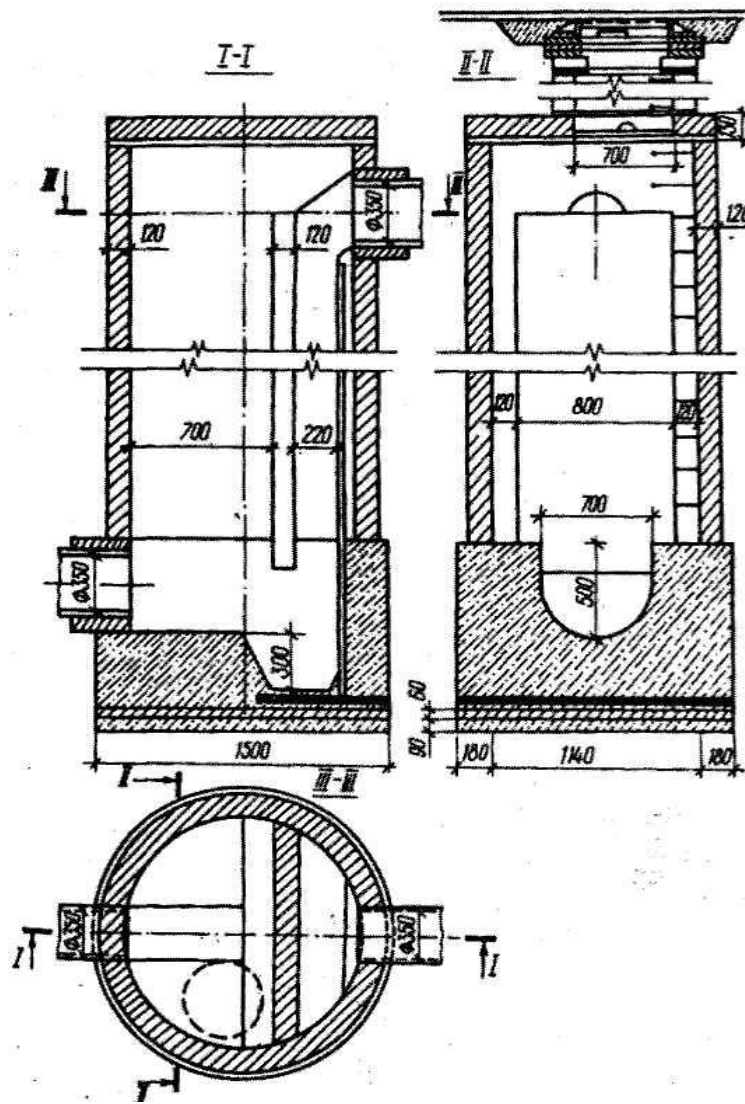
Перепадний колодязь із залізобетонним каналом
